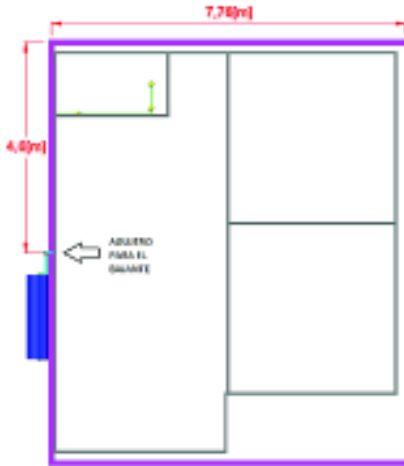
Dimensiones de las canaletas, Vista superior.
